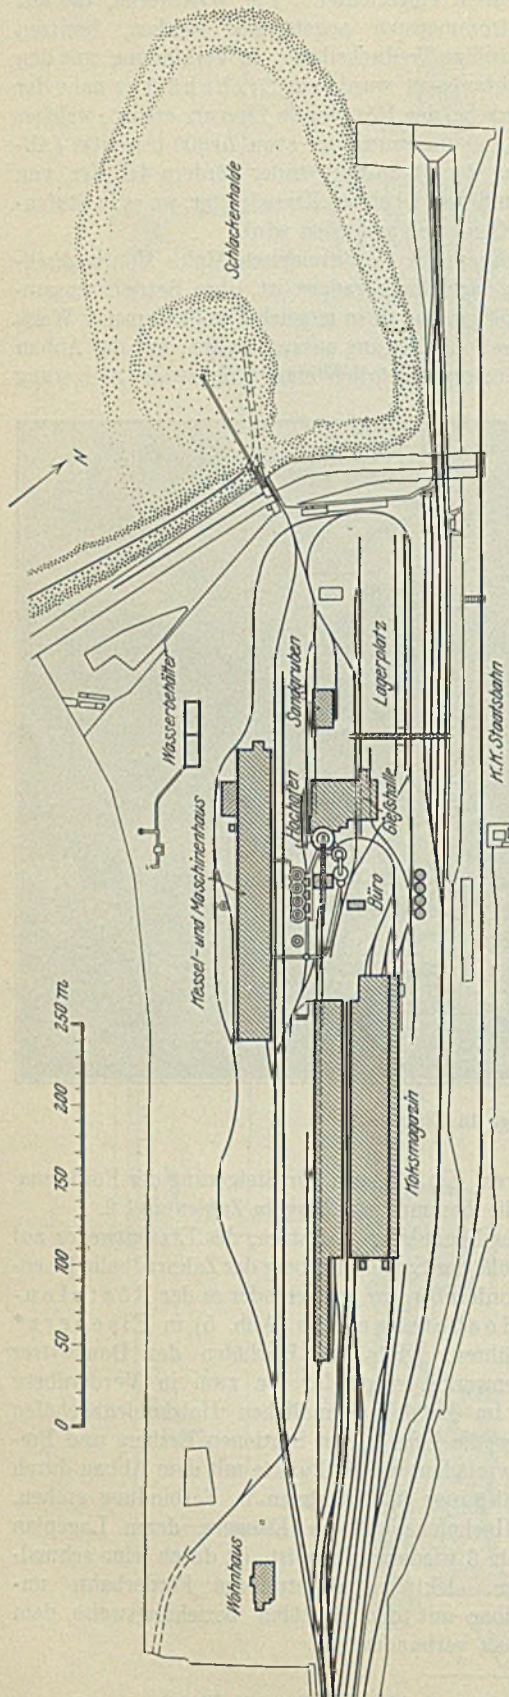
Lageplan der Hochofenanlage in Eisenerz.
